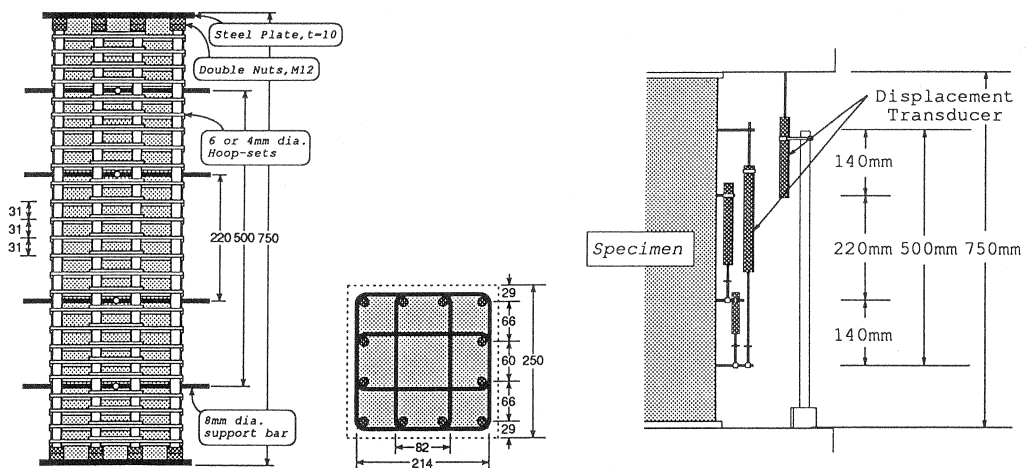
UNIT 1 の断面図、配筋図 (unit:mm) 及び電気式変位計の位置
